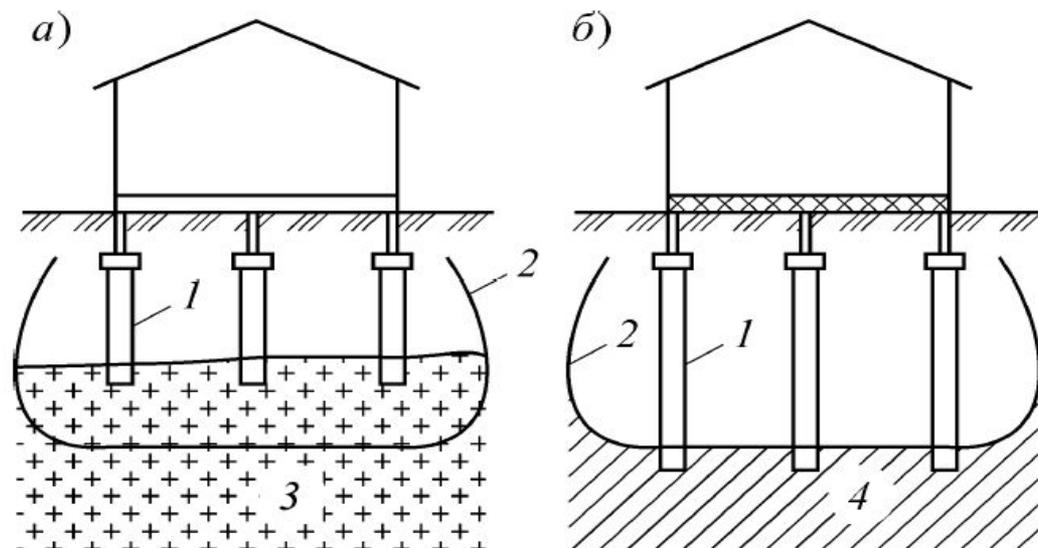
Схема свайных фундаментов при допущении оттаивания вечномёрзлых грунтов под сооружением:
